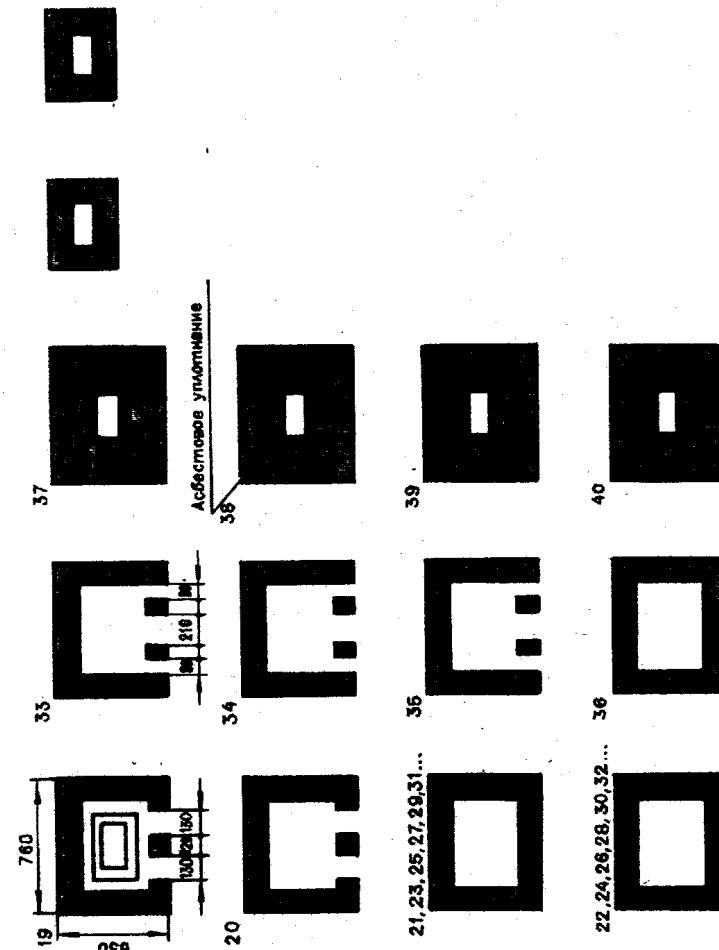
Камин повышенной теплоотдачи для помещения площадью 35–40 м²
